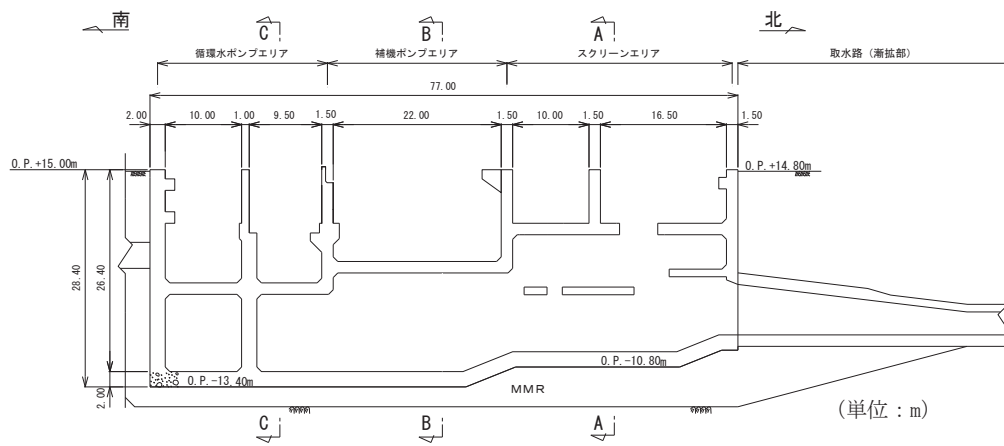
海水ポンプ室断面図 (D-D 断面, 南北)
